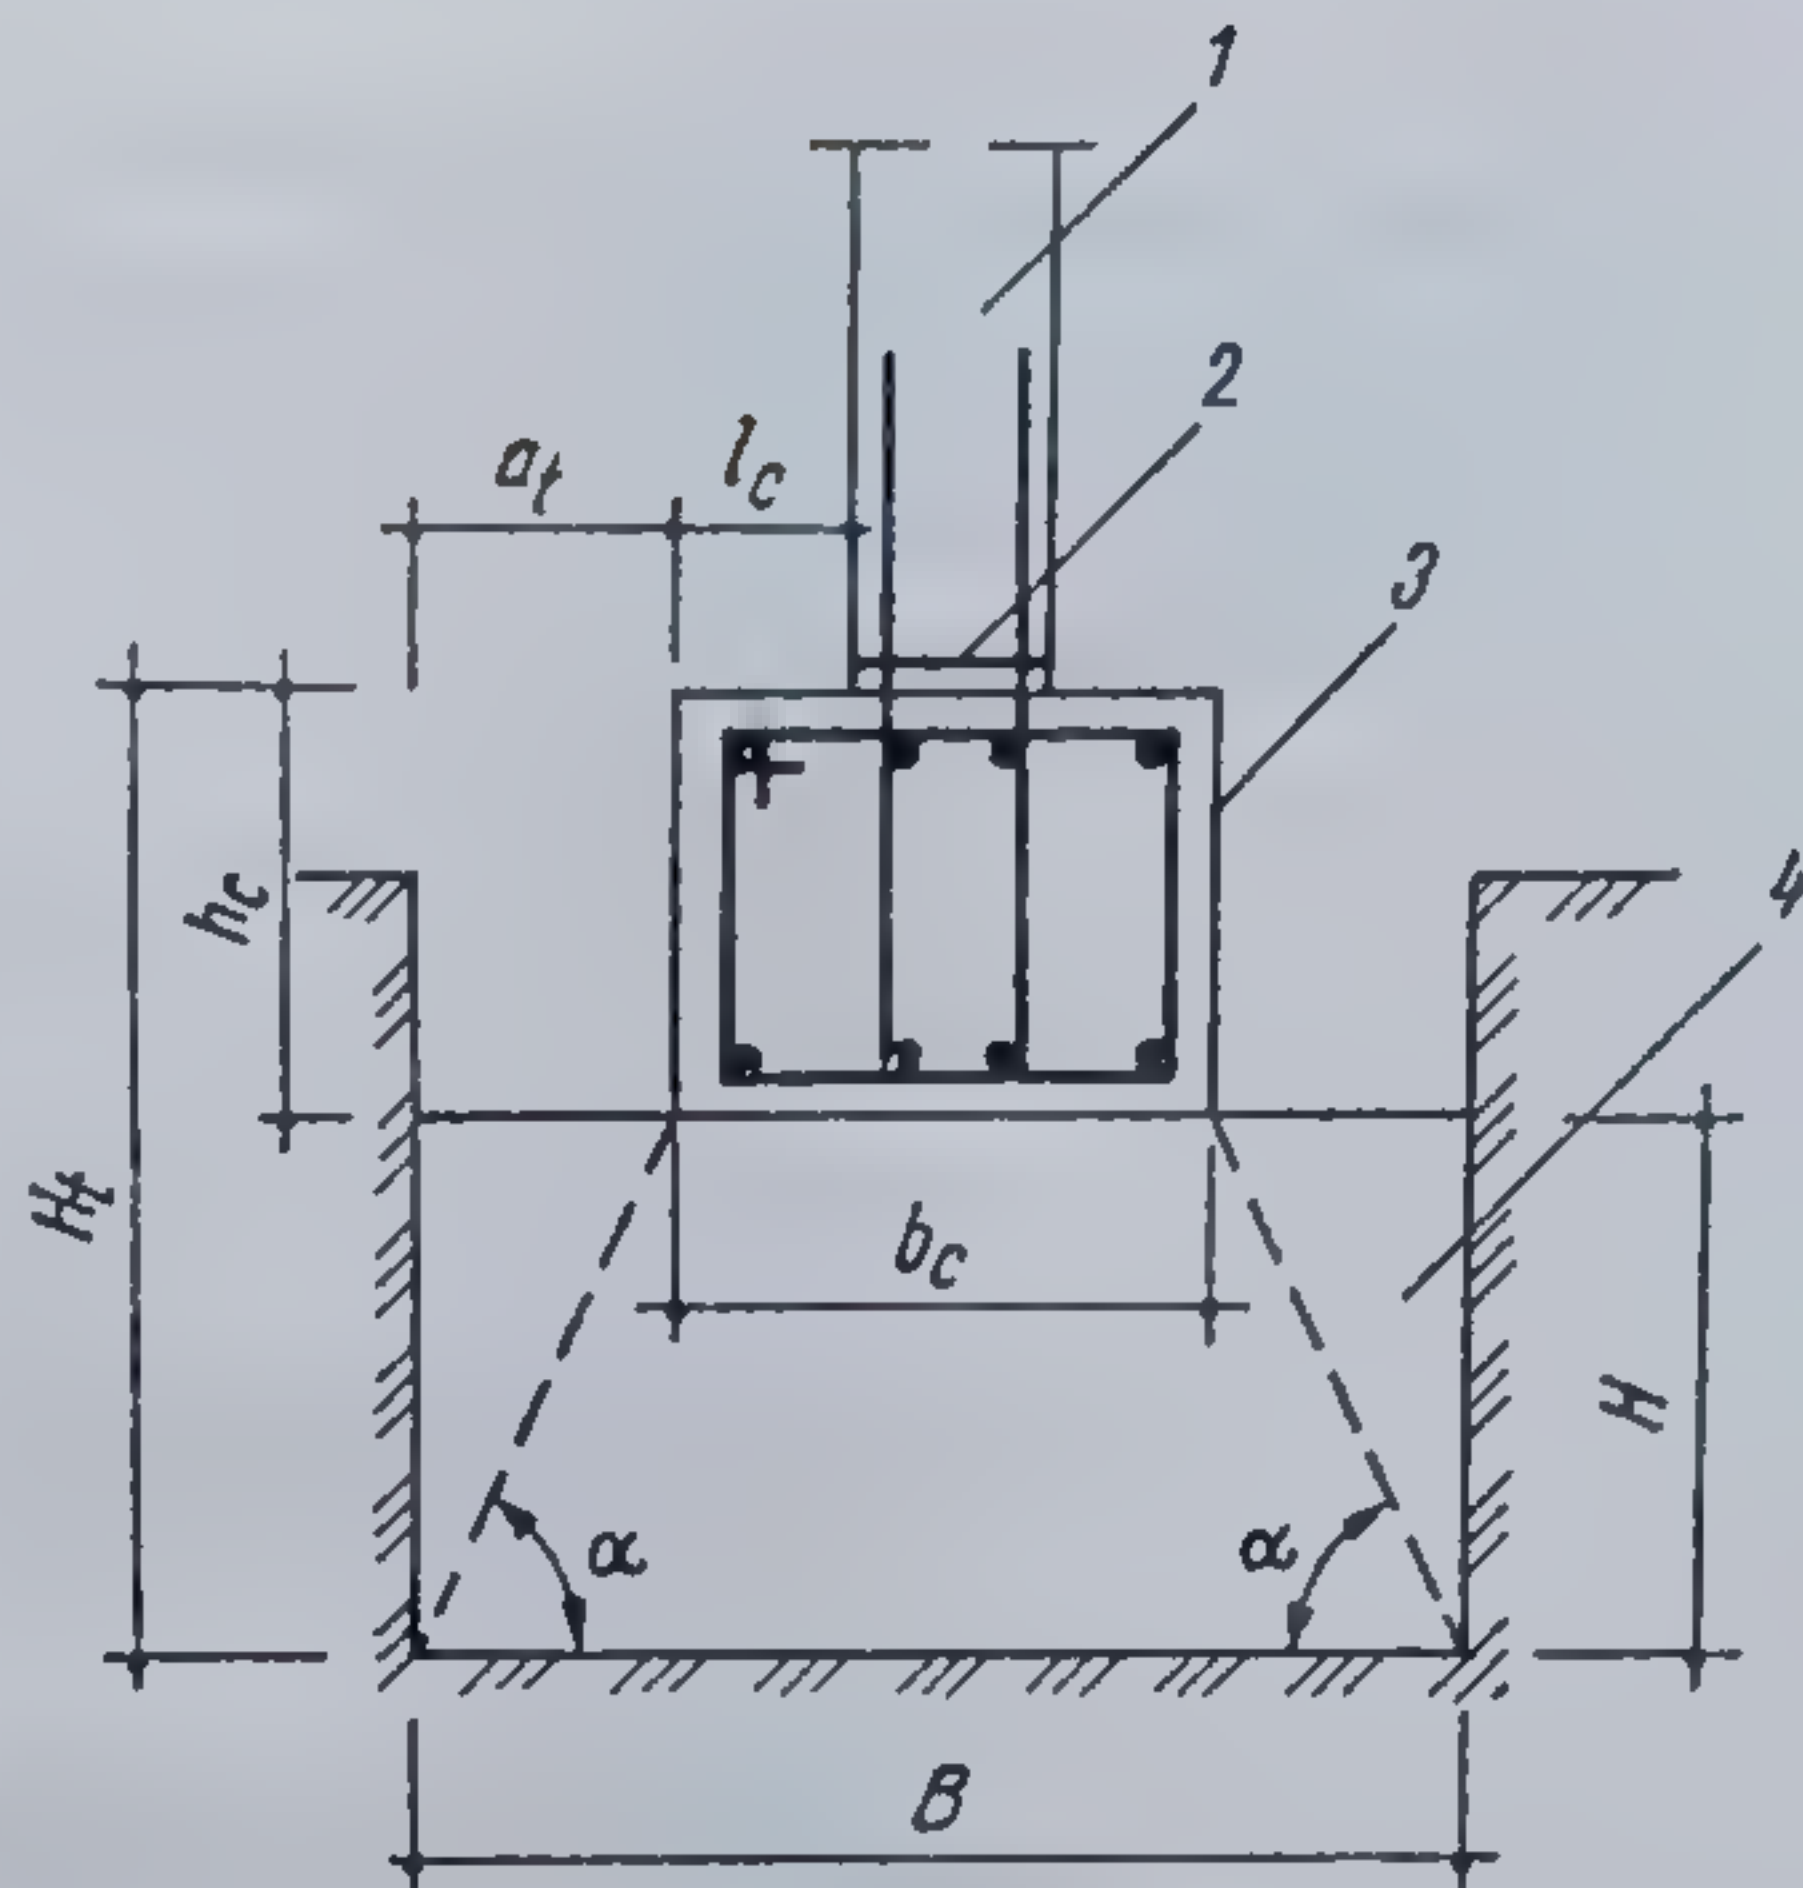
Fundație rigidă sub diafragmă din beton armat:
